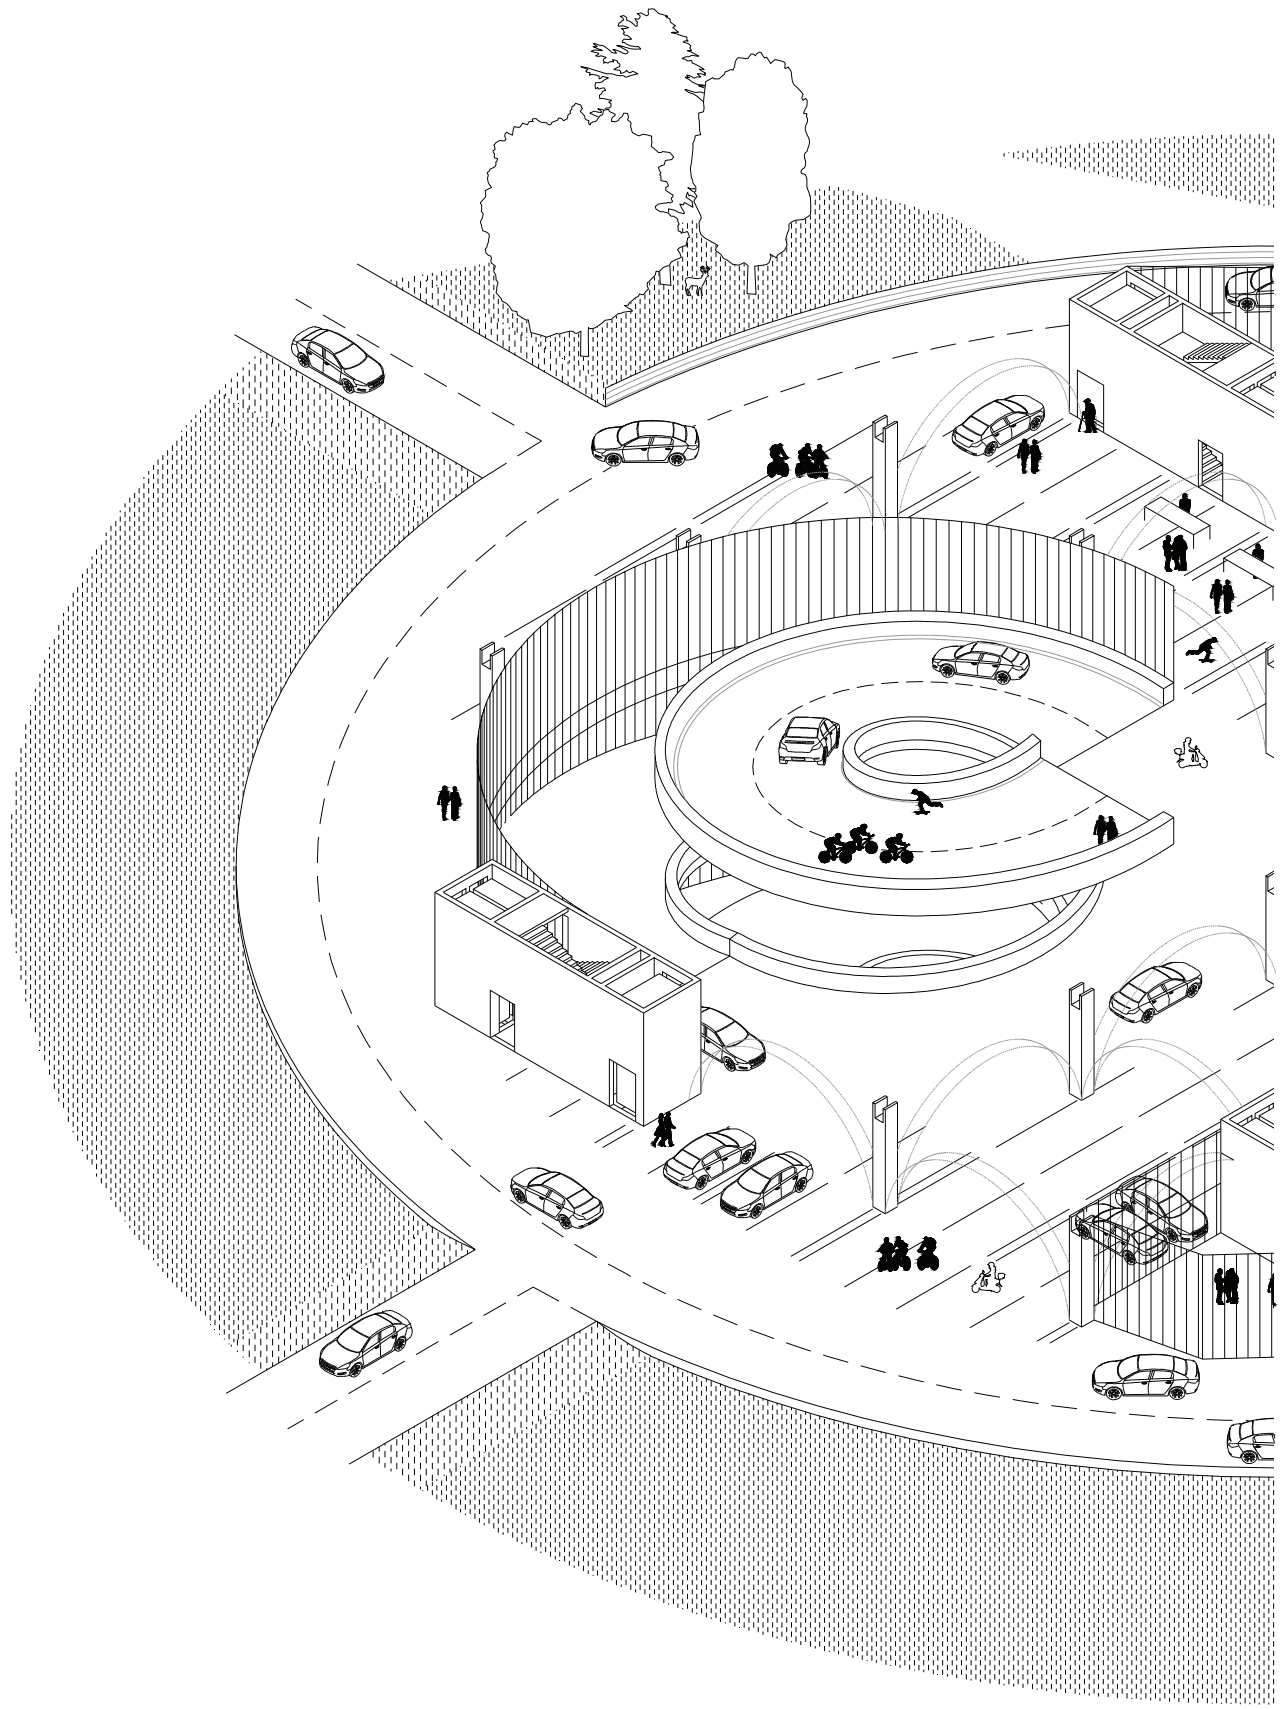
Grundrissaxonometrie . Logistikgeschoss . 1:400
